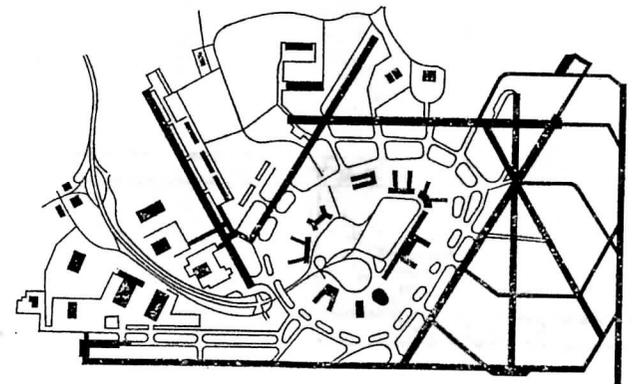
Схема генплана многополосного аэропорта Кеннеди (США)
